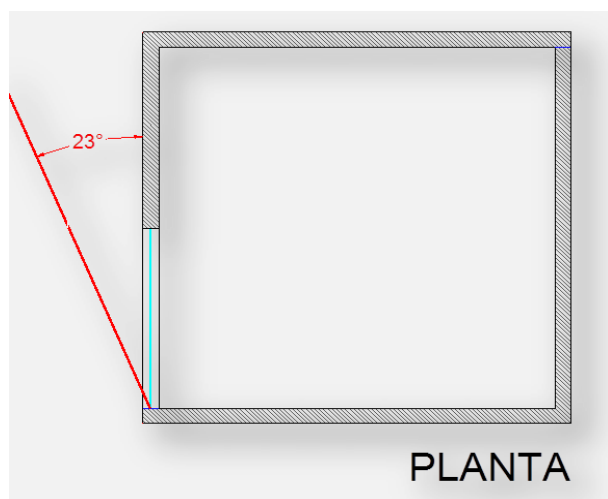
Trazo de ángulo para dispositivo vertical en planta. Fuente: Autor. AutoCad
